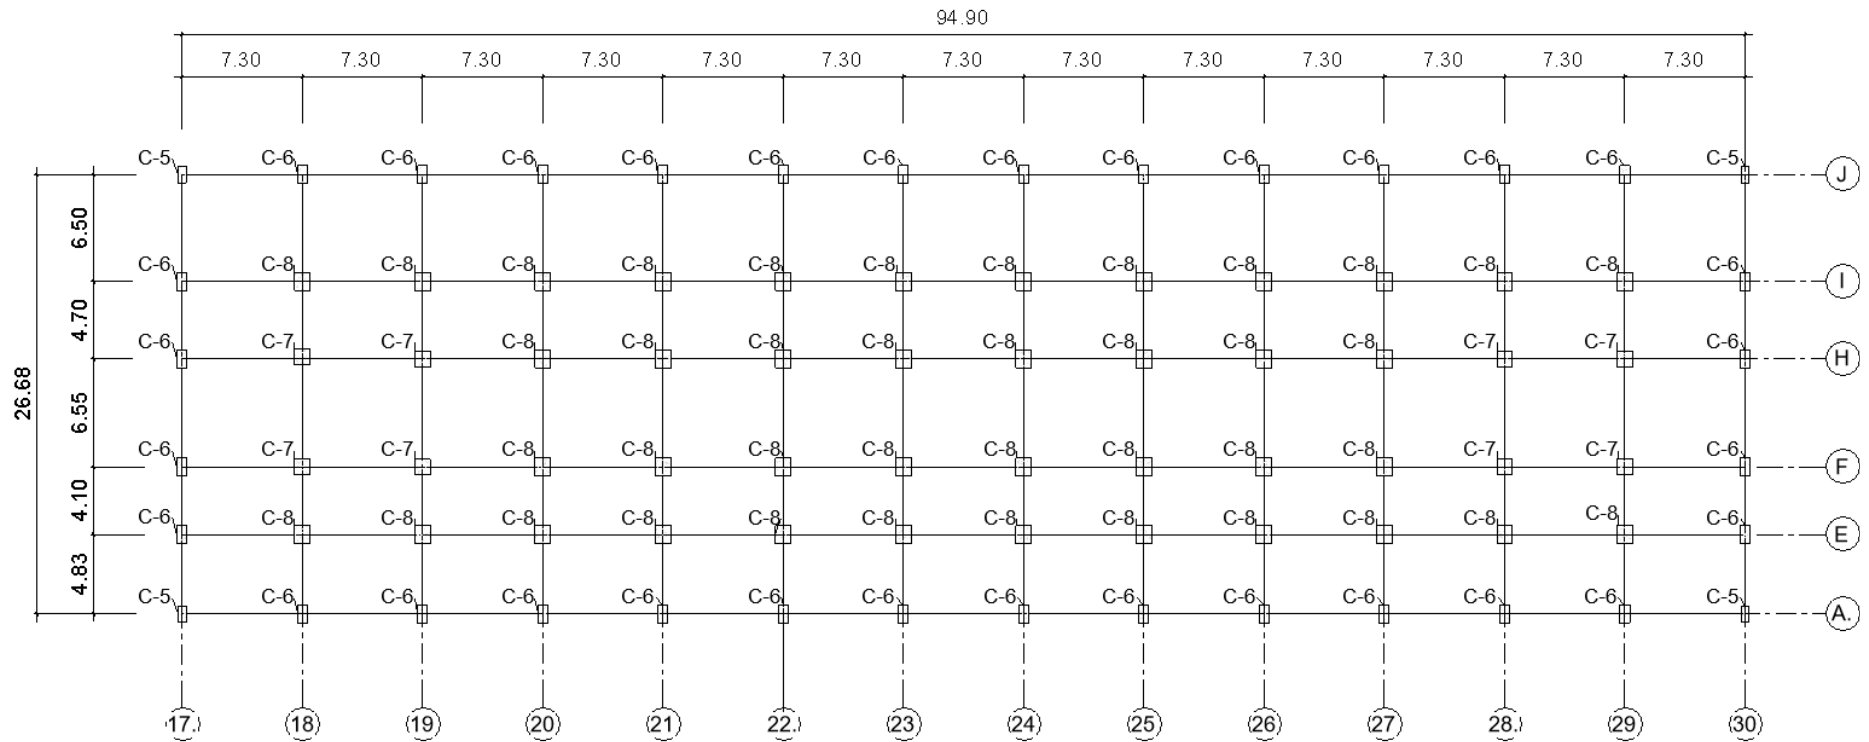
Planta Típica de la edificación (Pabellón A)
